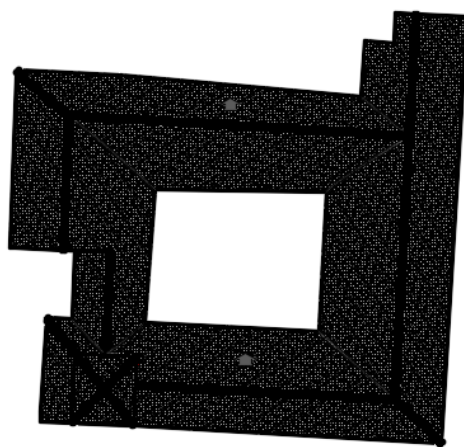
, vista cubierta casa Trujillo, Fuente: Autor propio, 2016.
